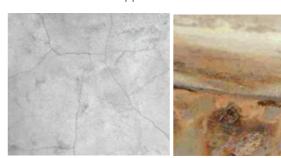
Fisuras en la superficie Foto 21. Corrosión en superficie del concreto de concreto
